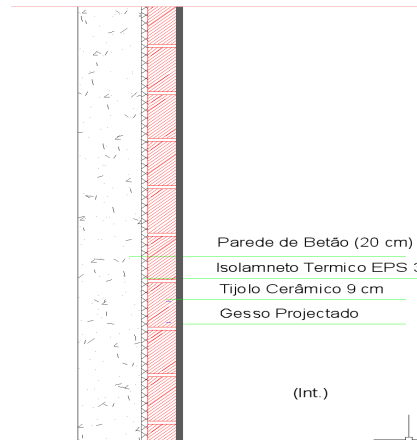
Solução Construtiva Parede Exterior ETIC’S)
